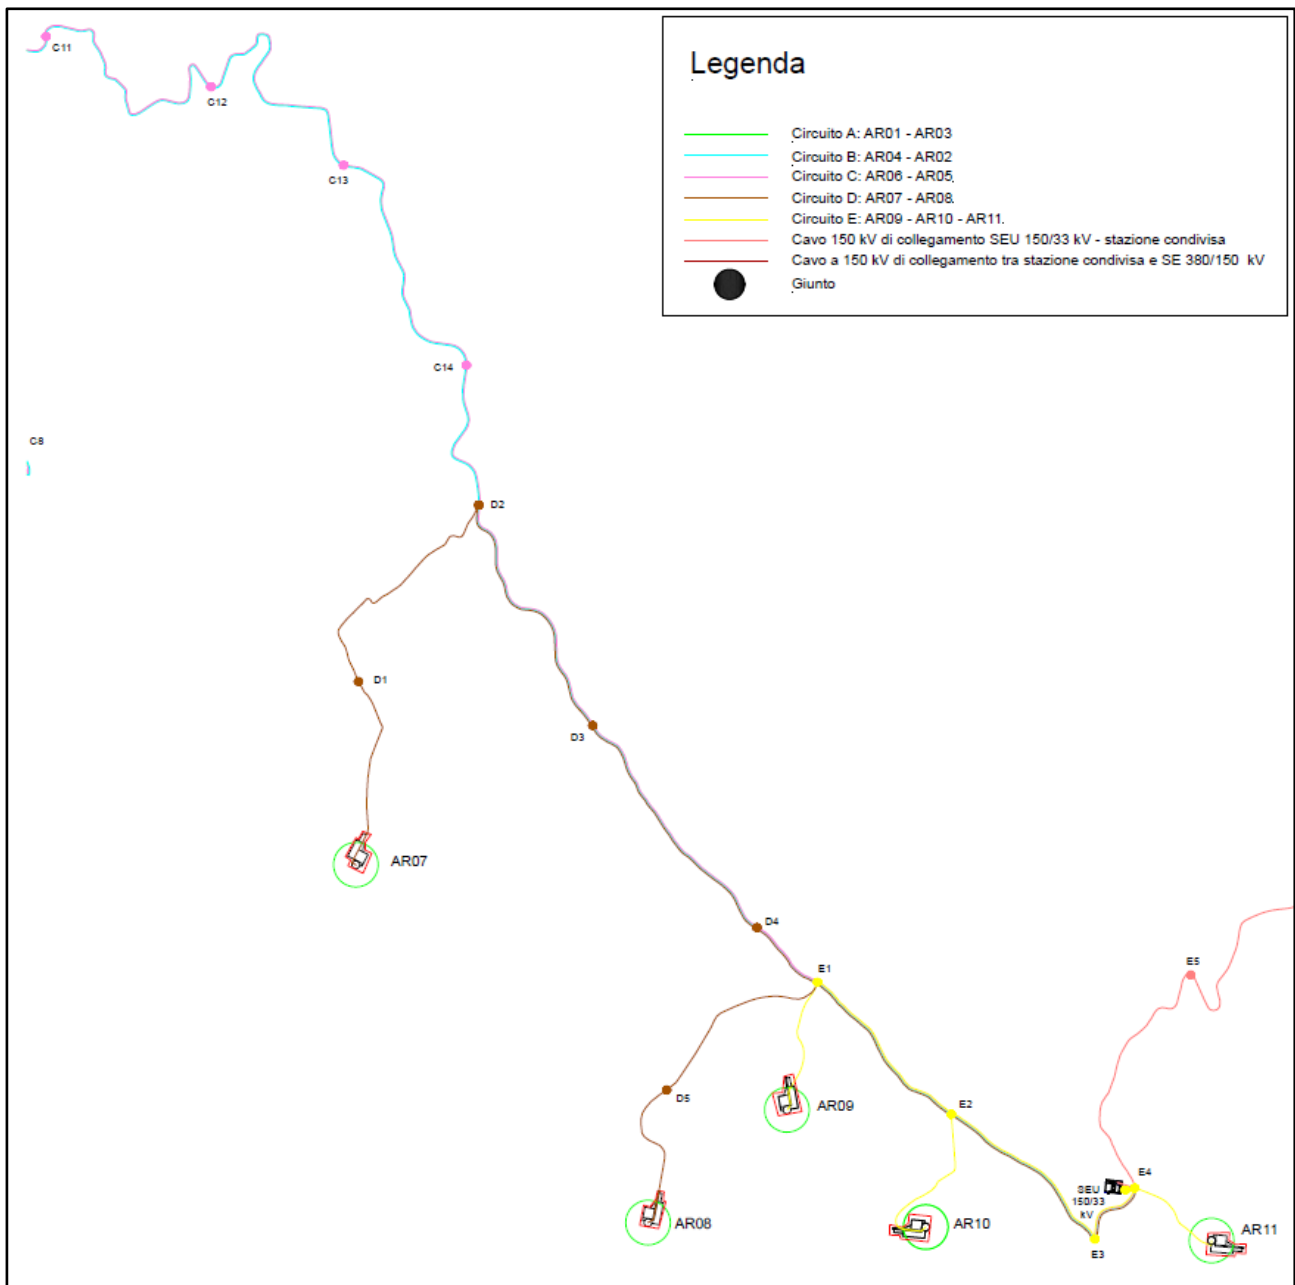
Dettaglio 2 - planimetria di distribuzione linee a 33 kV di collegamento
